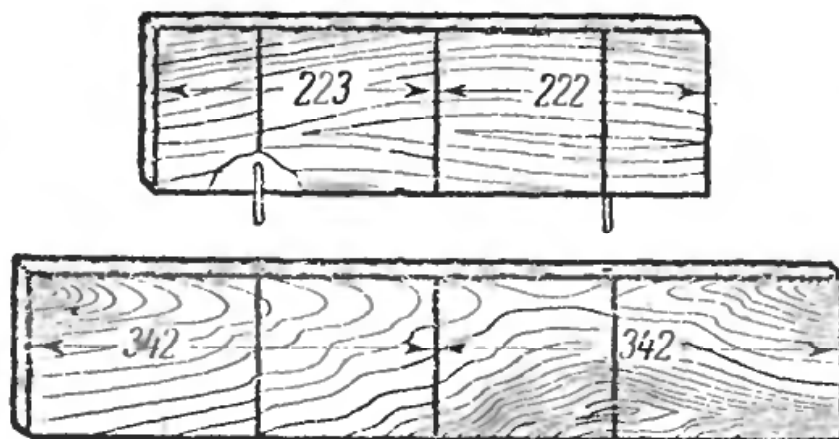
Разметка и сплачивание заготовок для фронтона крыши на шкантах.
